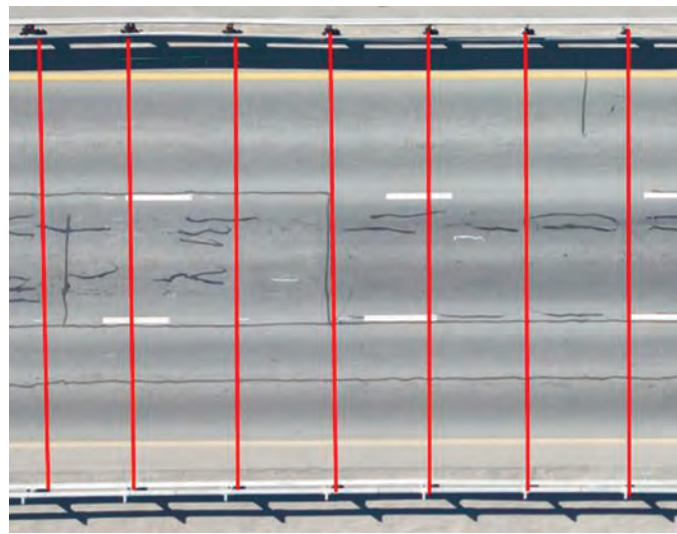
Распределение трещин в асфальтобетонном покрытии на ортотропной плите (красные линии — оси поперечных балок)
